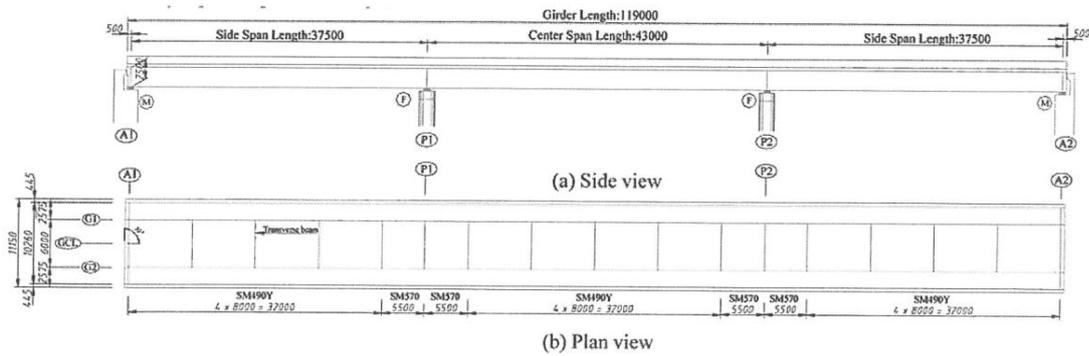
2主桁鋼コンクリート複合橋梁の平面図と側面図
